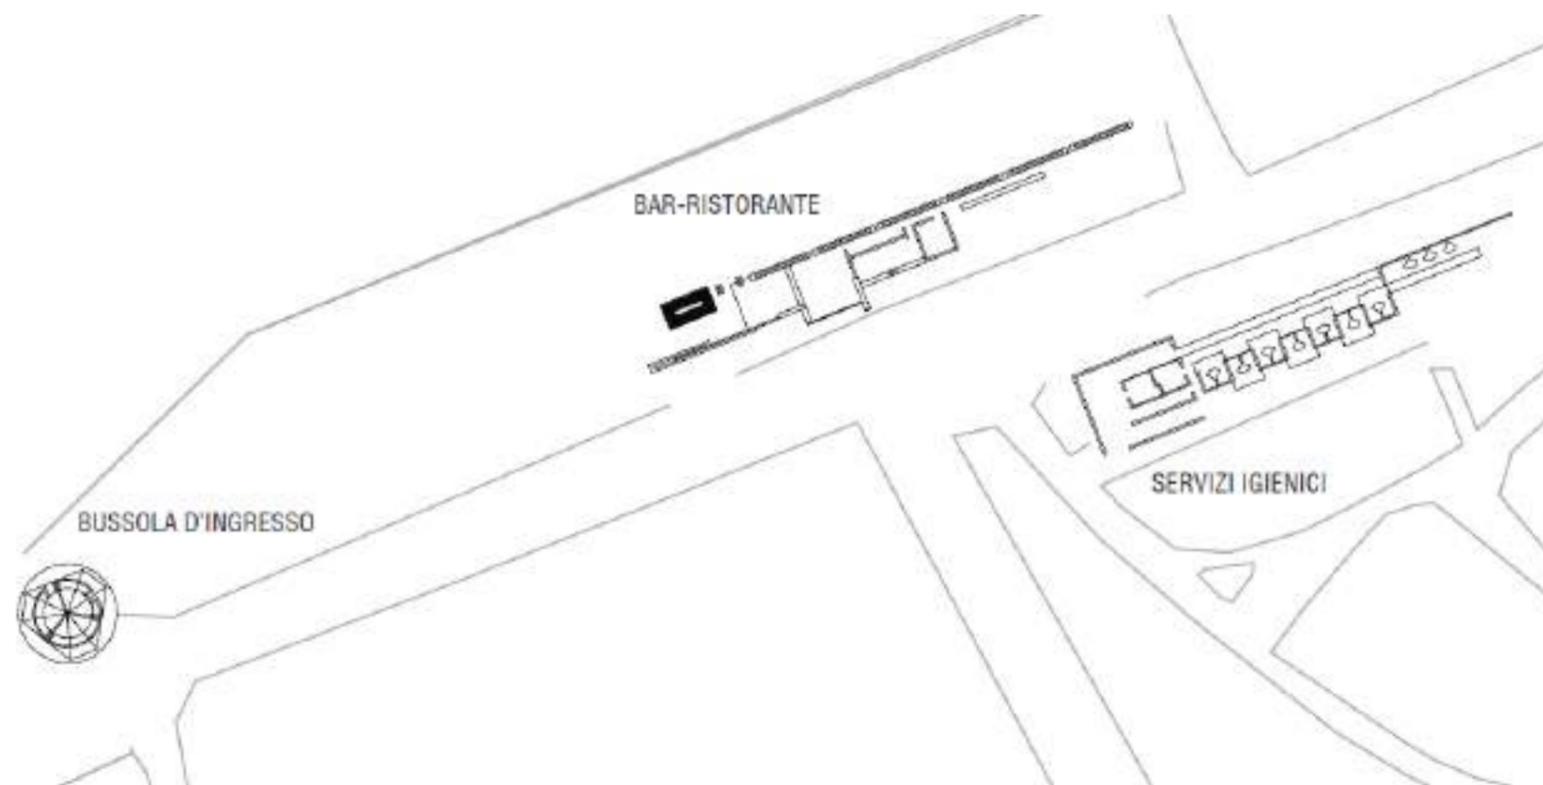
Planimetria opere dell'architetto Carlo Scarpa presenti all'interno del Camping Fusina
